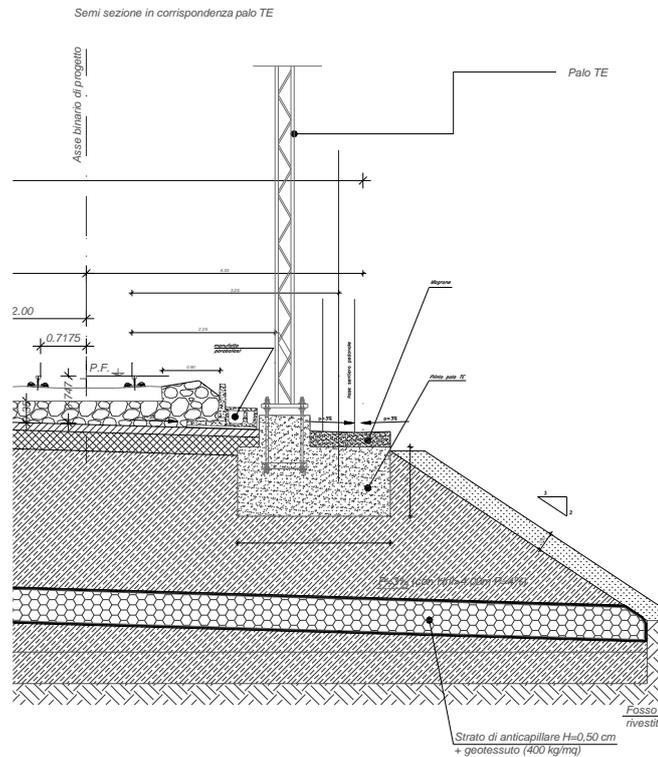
Dettaglio sezione con plinto che fuoriesce dal rilevato (Plinto per palo SLU)
